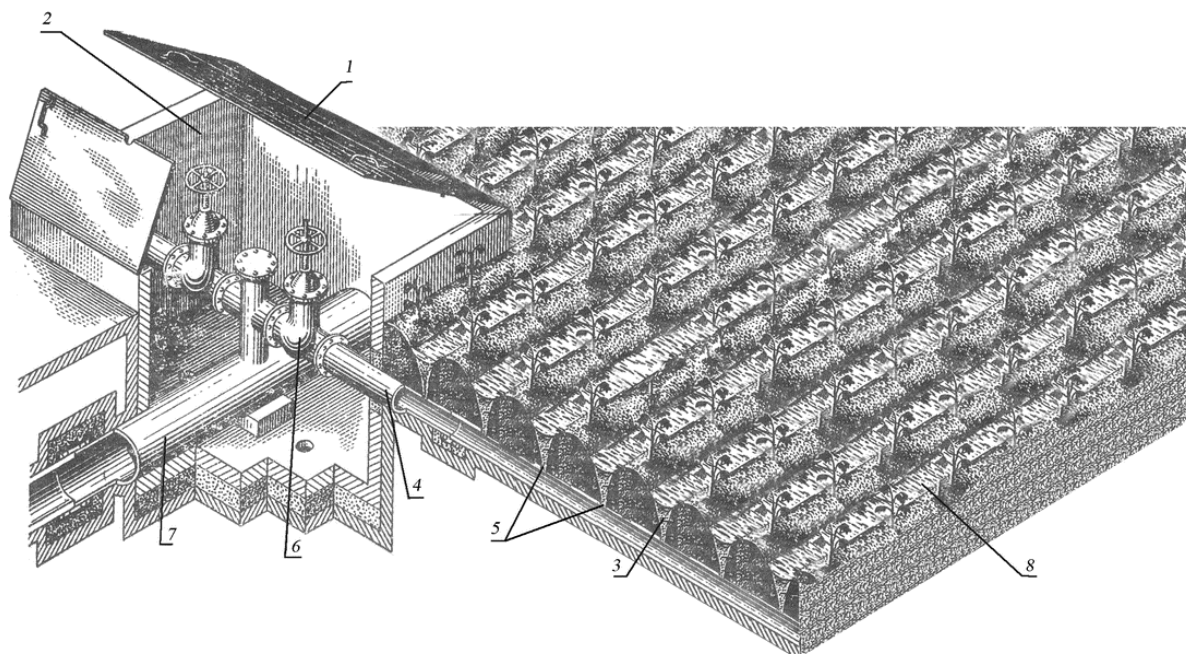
Закрытый перфорированный поливной трубопровод и распределительный колодец
